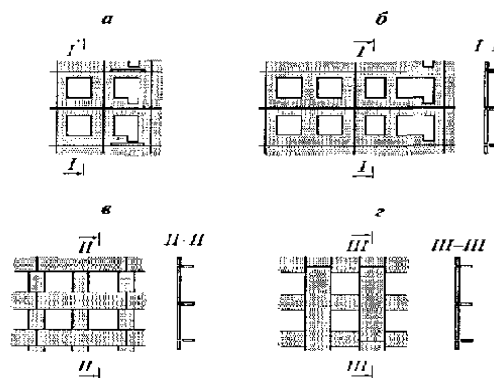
Схемы разрезки фасада здания на панели: а—на комнату с окном; б—на две комнаты с окнами или окном и балконной дверью; в—ленточная навесная панель; г—простеночные панели на два этажа с подоконными вставками.
